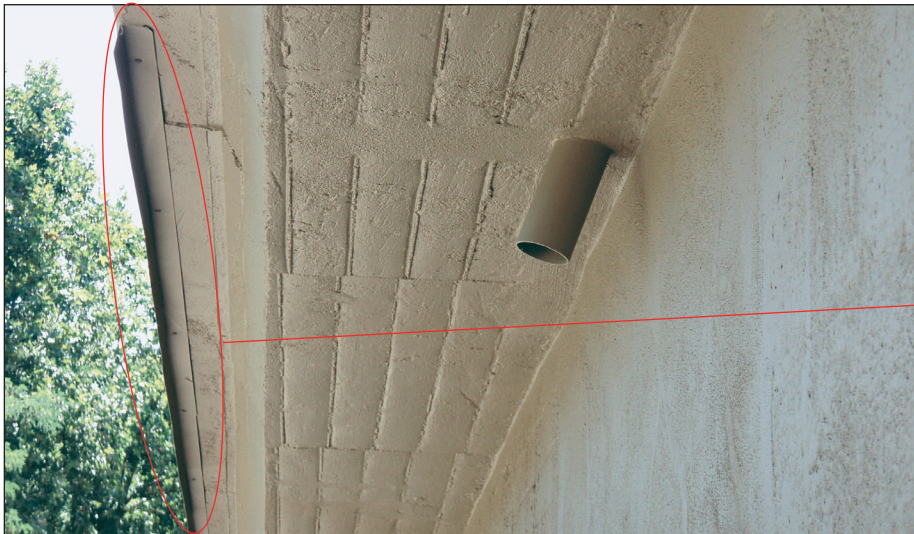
Y 175. ELEMENTOS DEL SISTEMA DE DRENAJE: GÁRGOLA.
